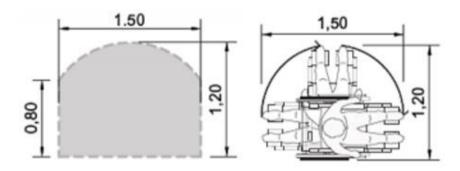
Demonstração giro de 180º que deve ser representado na planta de layout
